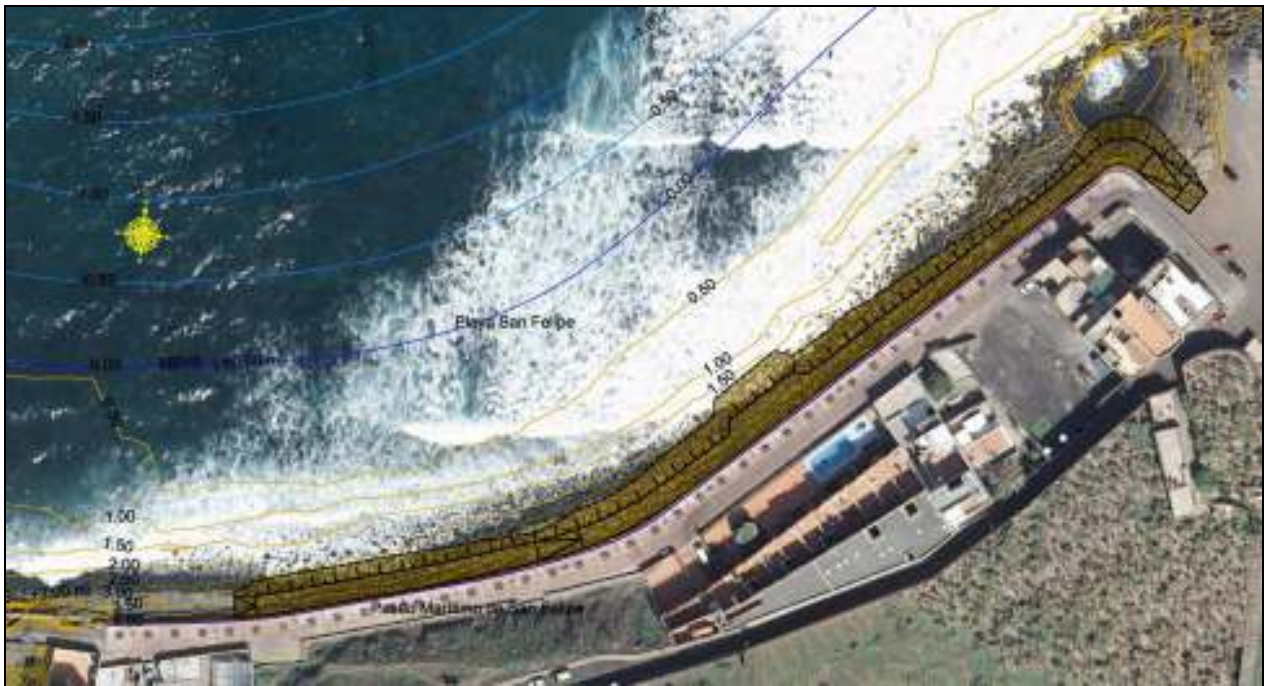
Trazado en planta del camino provisional de acceso durante la fase de obras
